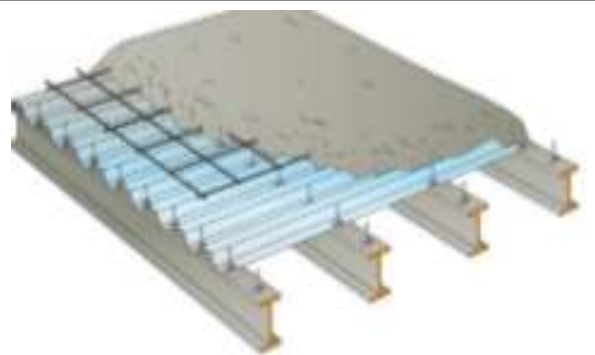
Plancher mixte . Source: PDF La solution intelligente
